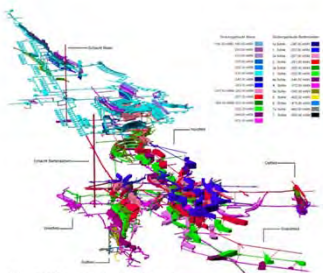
Grundrissplan, Ansicht von Süd nach Nord
